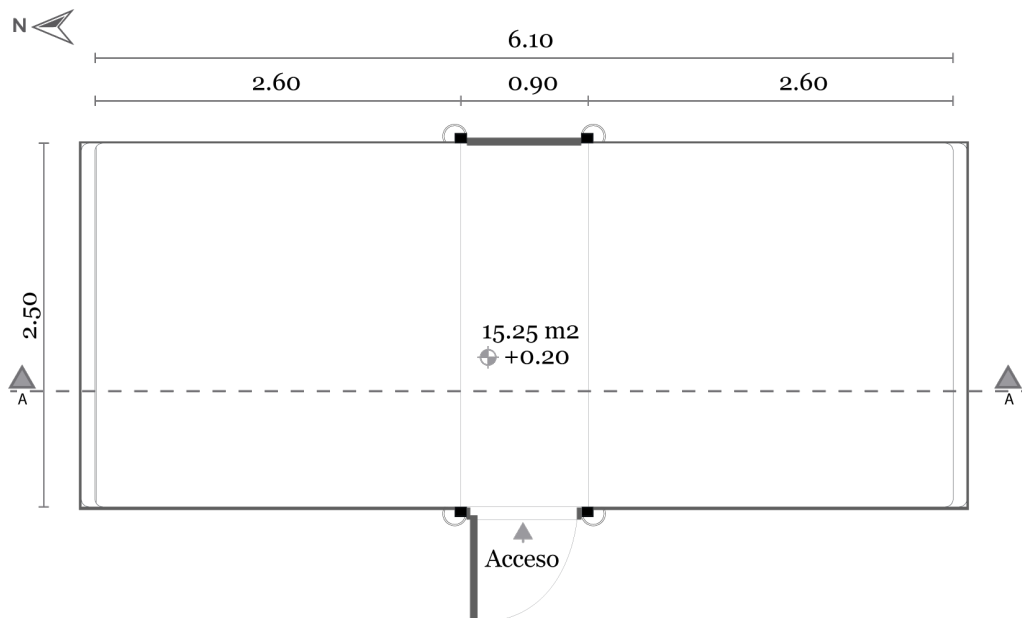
Planta arquitectónica Cmax System. Elaboración: Los Autores.
